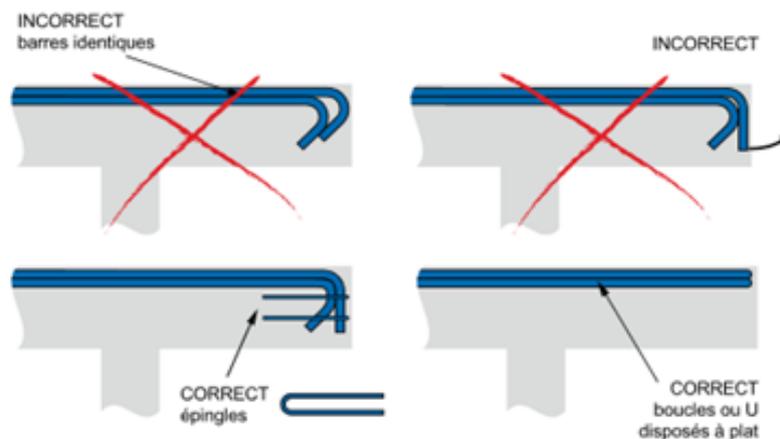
Exemples de poussée au vide d'ancrage et solution alternative [18]
